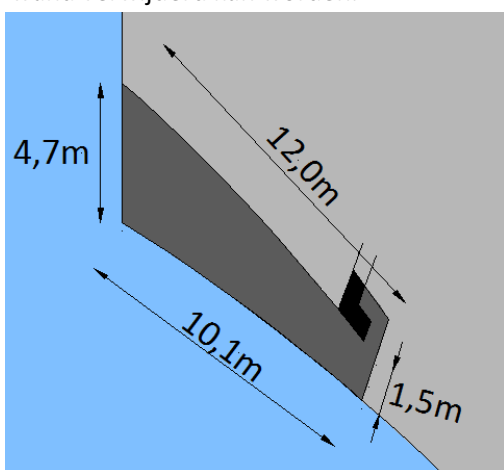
Noodzakelijke afmetingen wegneembare constructie
